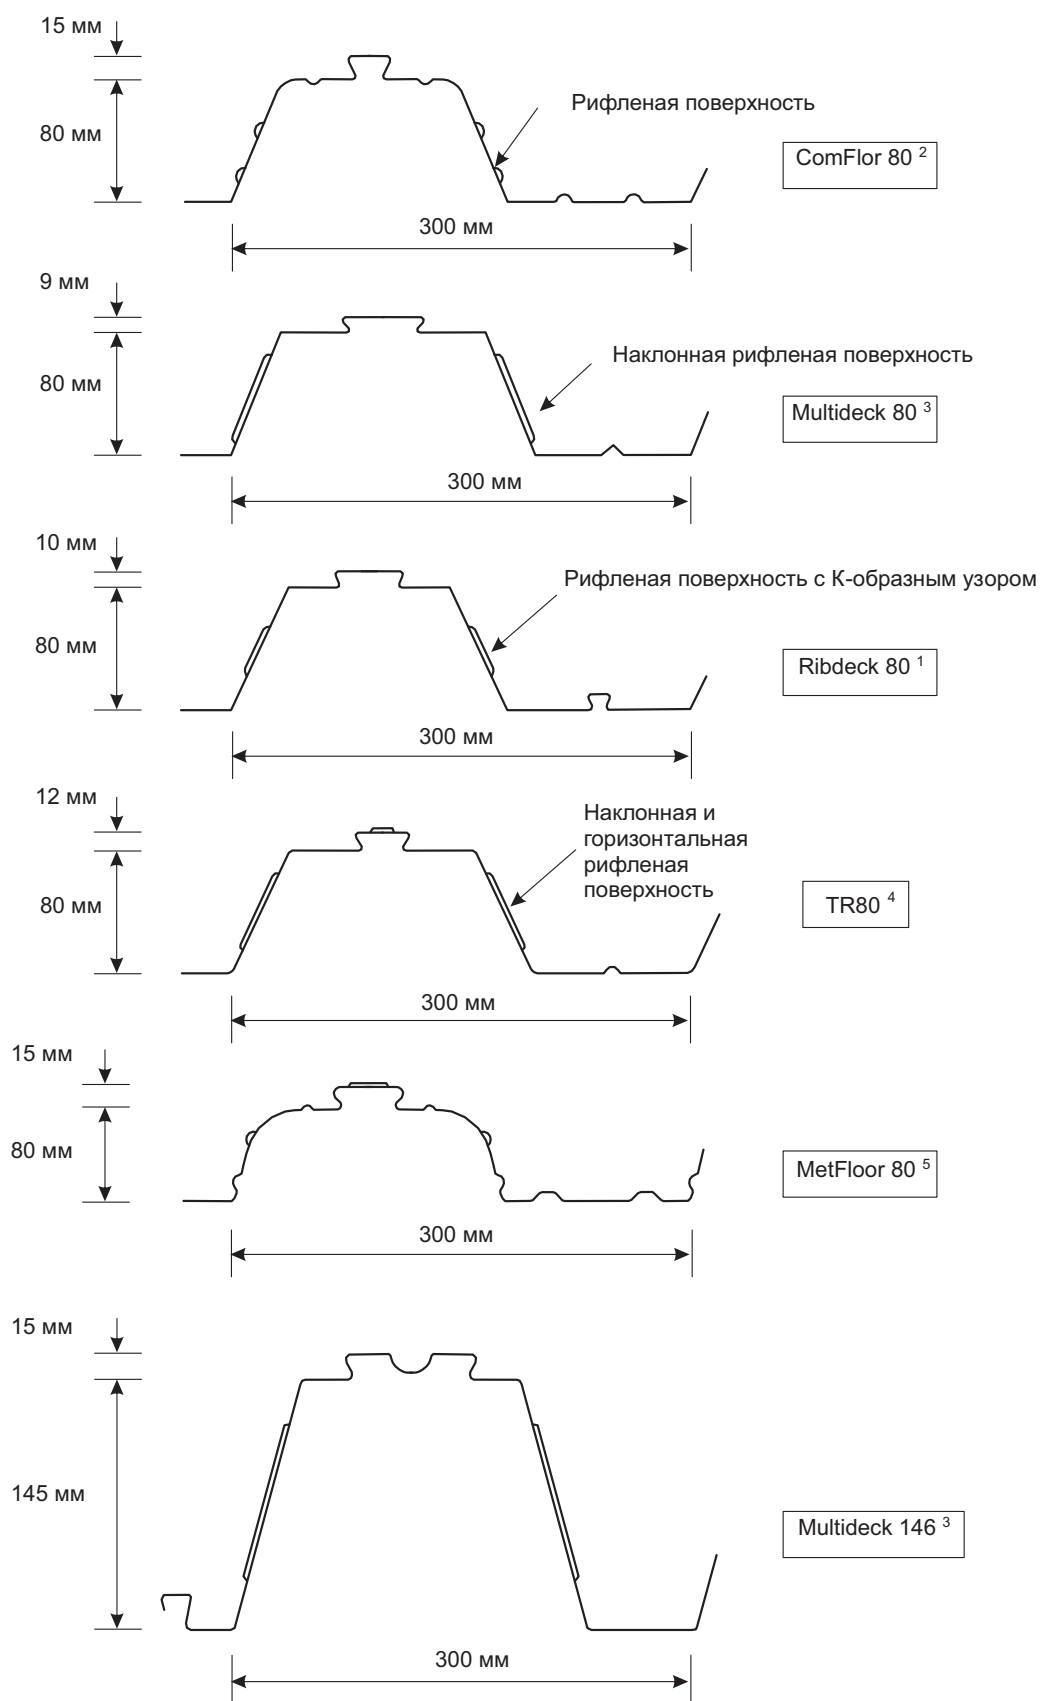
Образцы настила с трапециевидным профилем высотой более 60 мм (без учета верхнего элемента жесткости), применяемого с комбинированными перекрытиями, поставляются следующими производителями.
